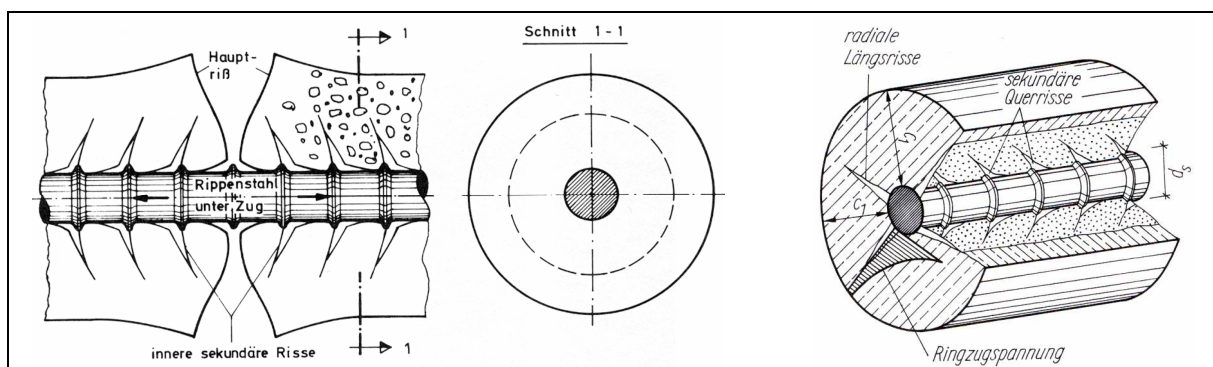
Beanspruchung der Betonkonsolen [Goto (1971)]
